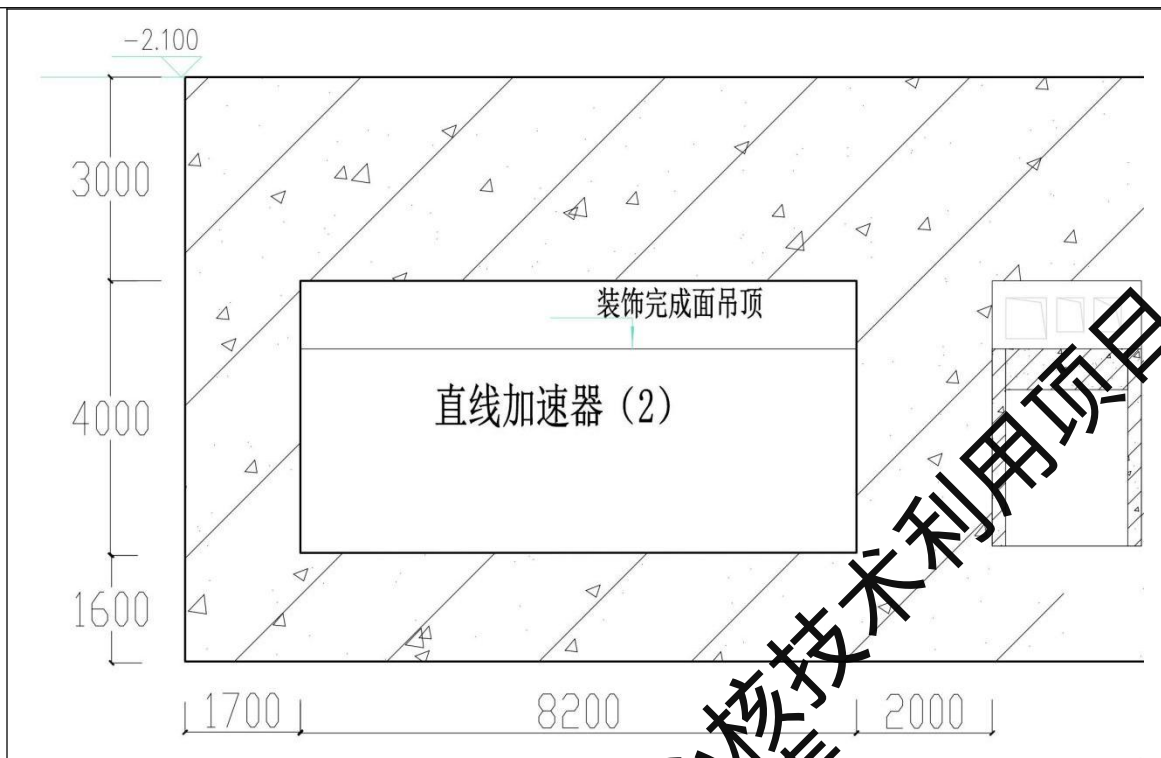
加速器机房屏蔽示意剖面图 (剖面 1-1) (单位: mm)
